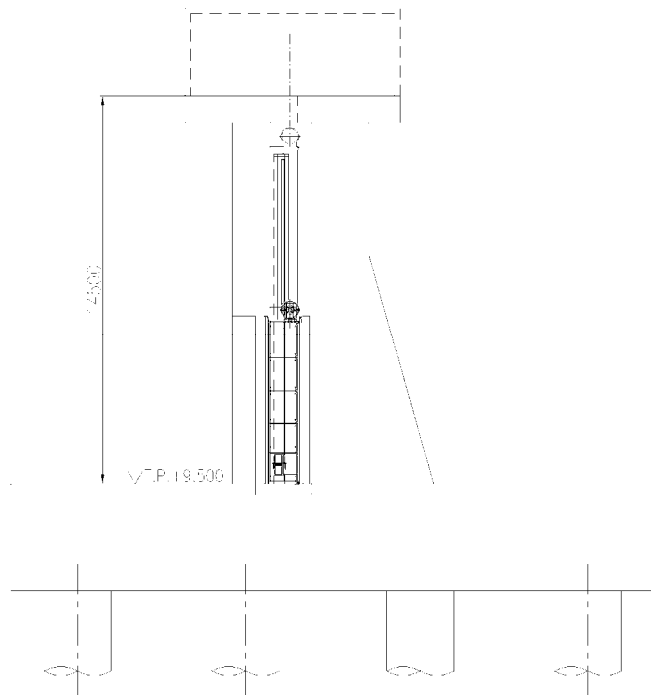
鉄筋コンクリート防潮壁断面図（防潮扉 2）
